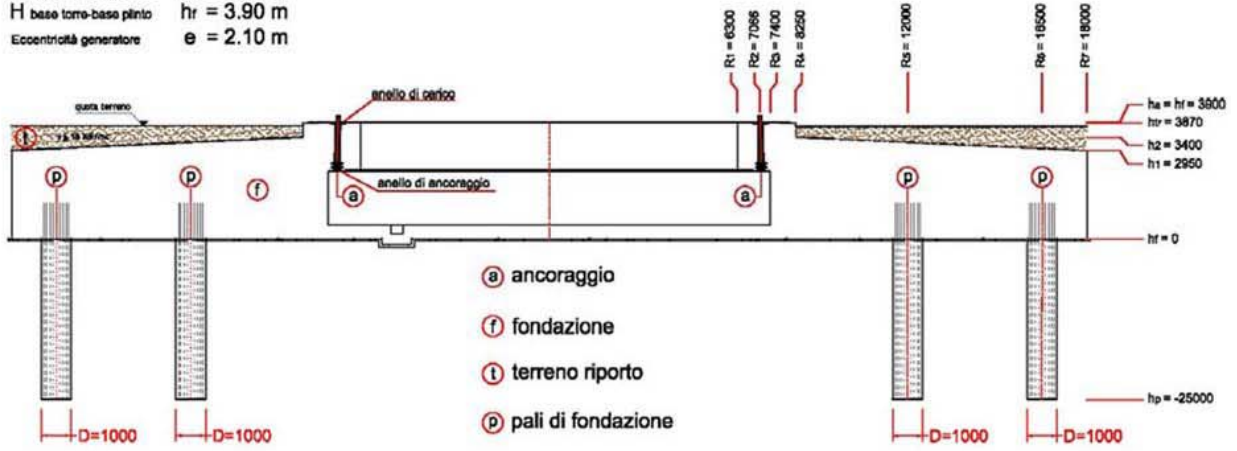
Pianta Plinto di fondazione per la configurazione di progetto stimata nell'area di intervento
